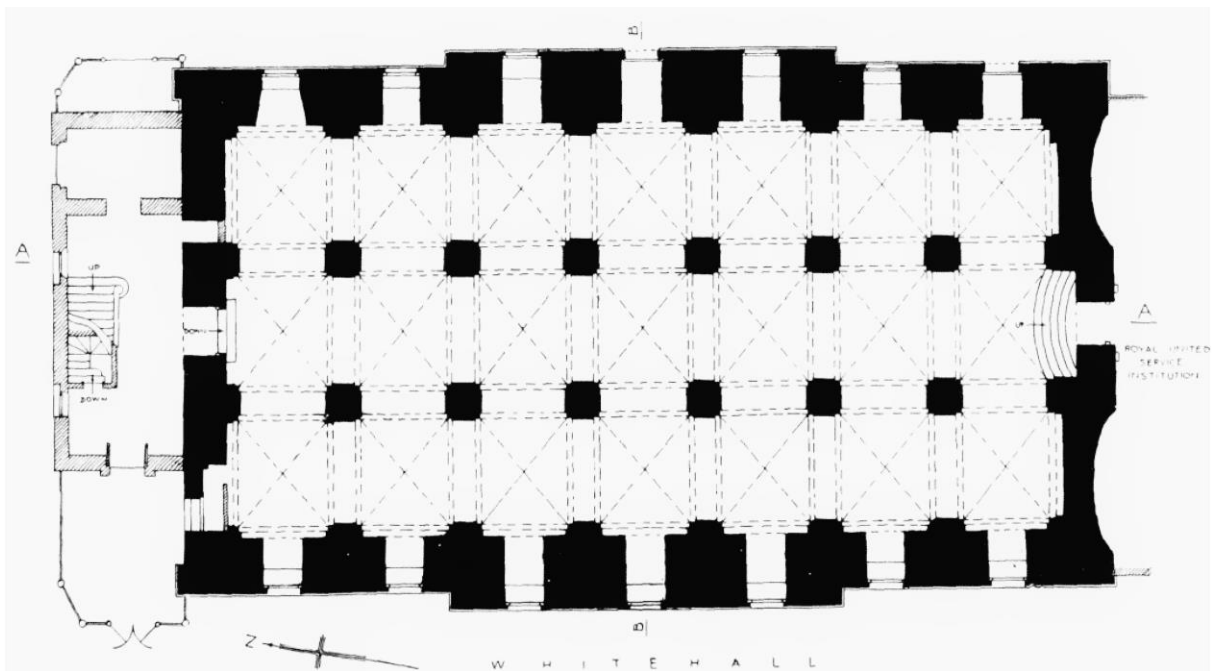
Inigo Jones: *Banqueting House*, Grundriss Sockelgeschoss, Whitehall/London, 1619 – 1622
